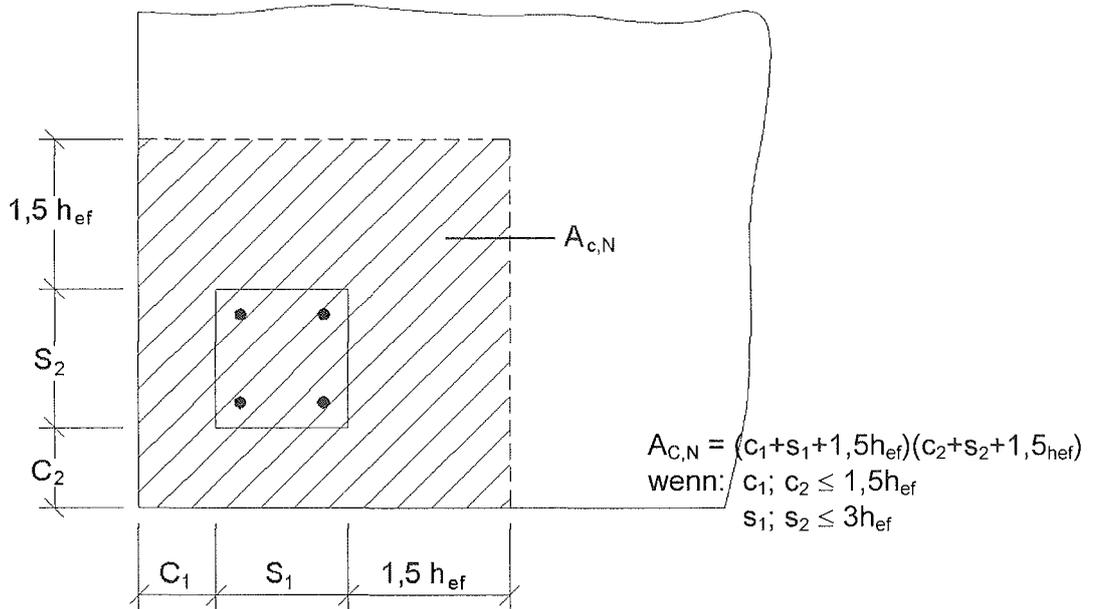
Beispiel für die vorhandene Fläche $A_{c,N}$ des idealisierten Betonausbruchkörpers unter Zugbeanspruchung der Ankerbolzen
